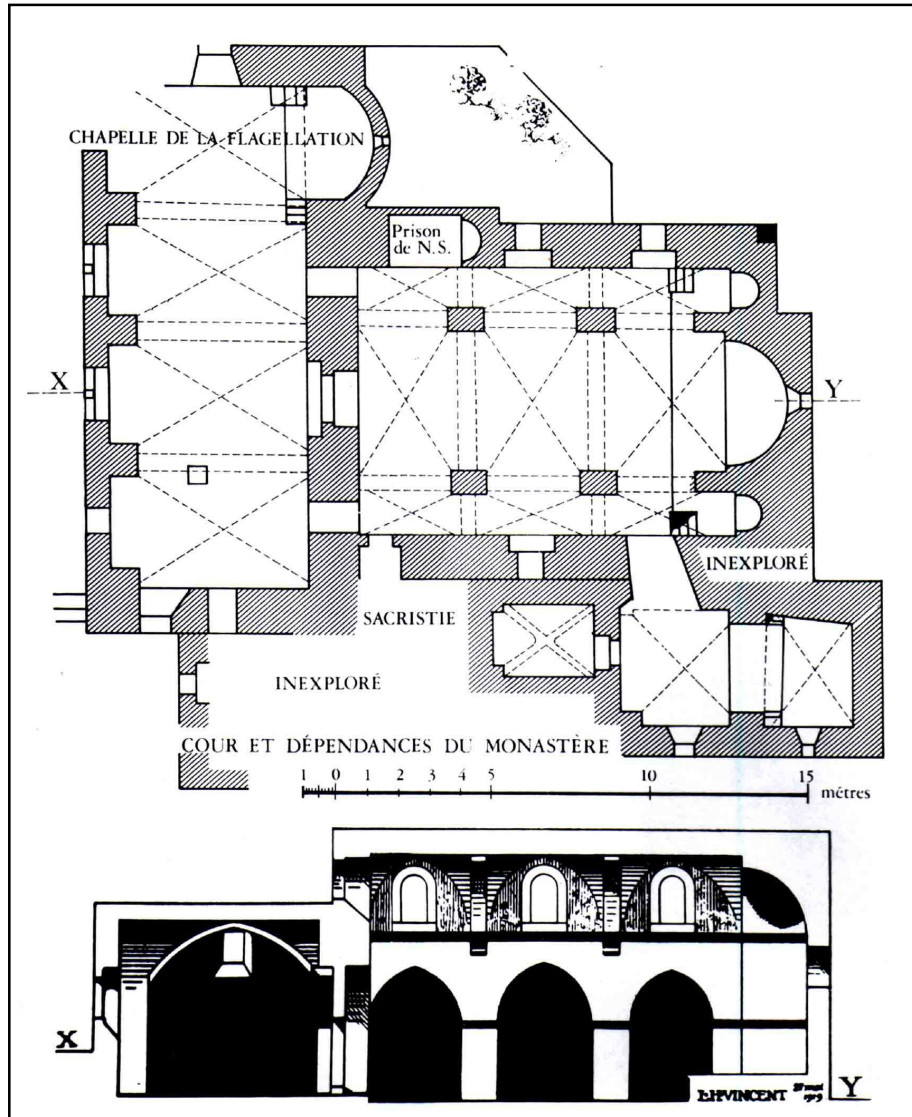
مسقط أفقي لكنيسة يوحنا المعمدان.
